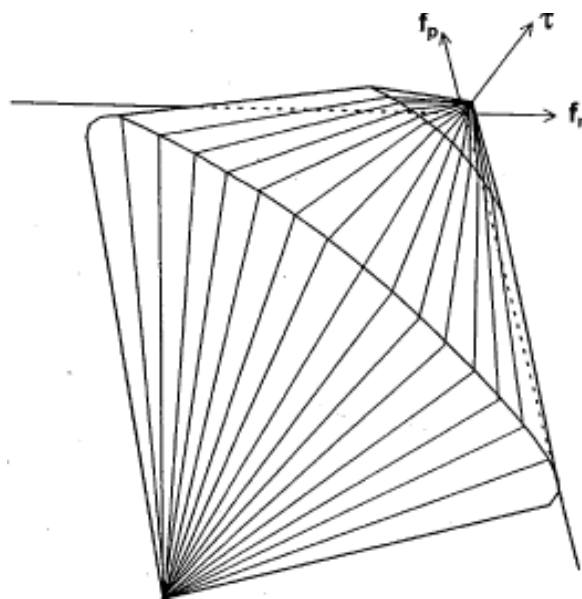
Vista en planta de la superficie de falla de la mampostería.
